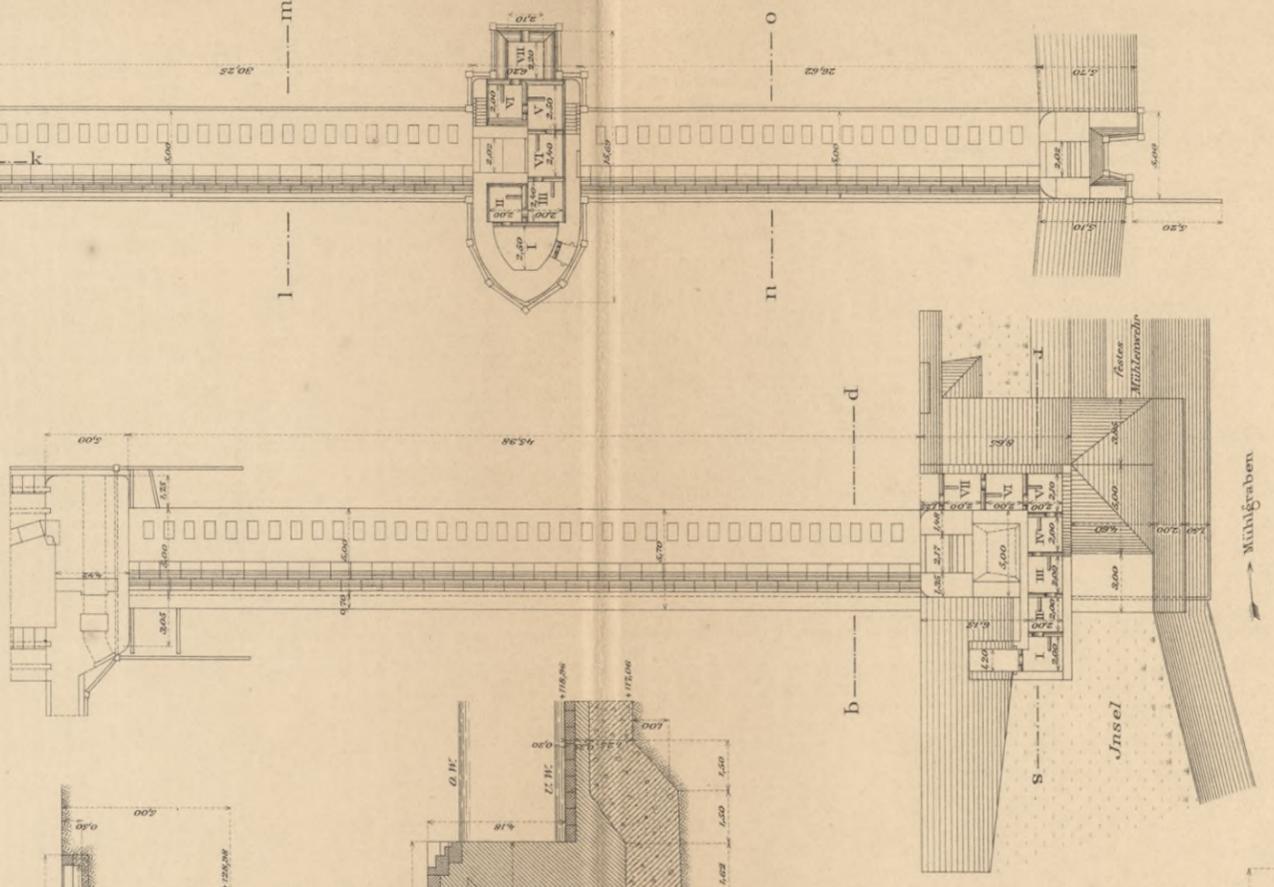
Grundriss des Nadelwehres bei Speele. 1:400.
